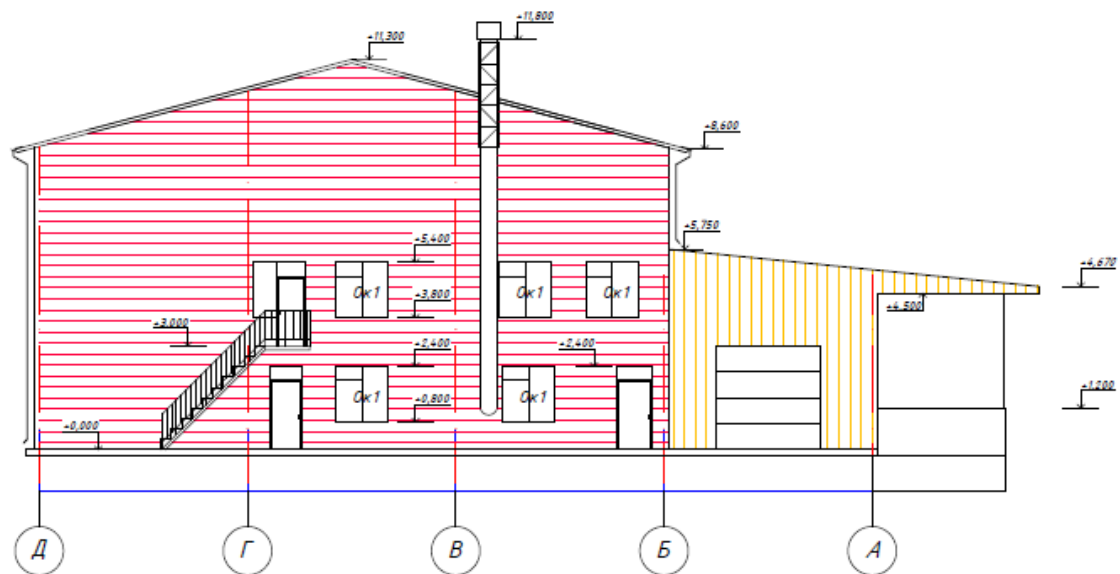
Схема будівлі для розрахунку зовнішньої організованої системи водовідведення дощових вод з покрівлі будинку.
